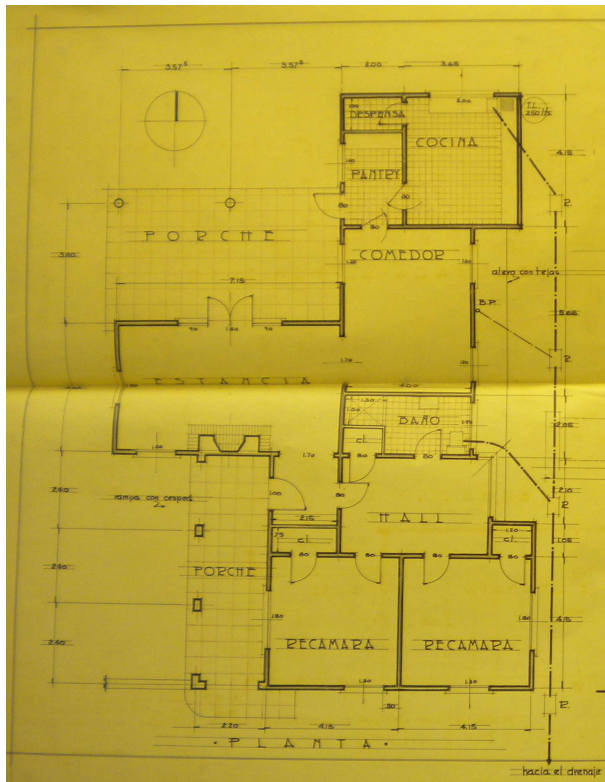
Planta arquitectónica del proyecto de Casa habitación para el Sr. Julio V. Escalante.
